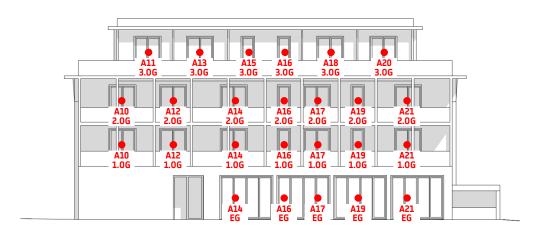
Immissionsorte Haus A, Südostfassade. Fassadenansicht 1:250.
